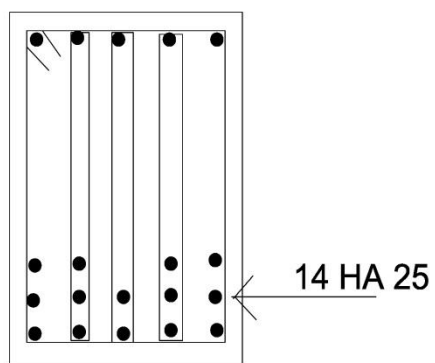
Coupe transversale sur appui d'une nervure transversale.
